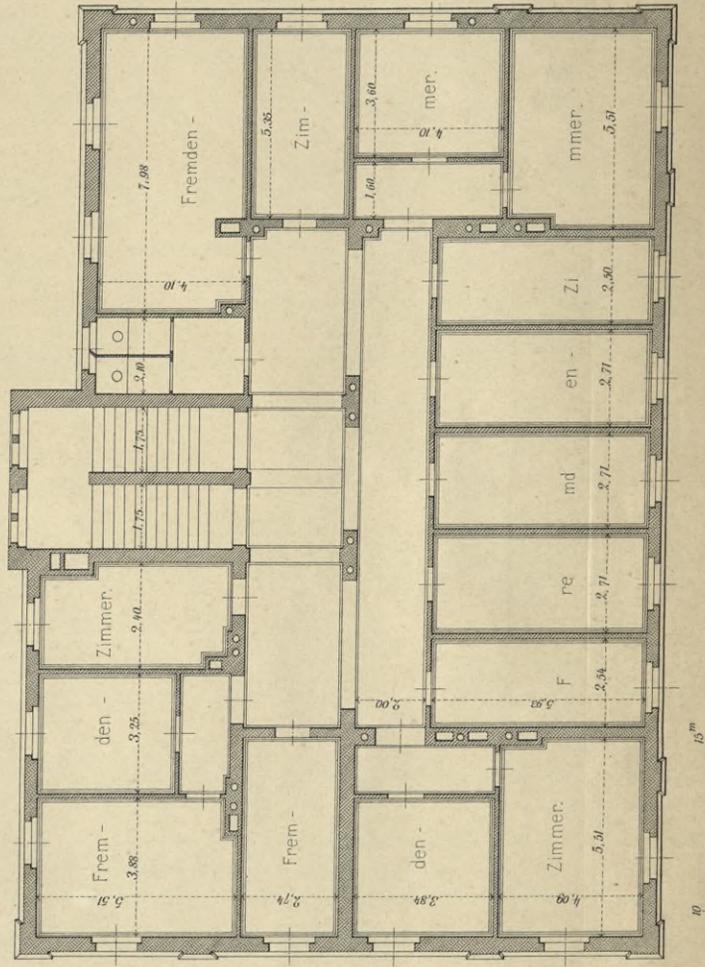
Grundriss des zweiten Obergeschosses.
